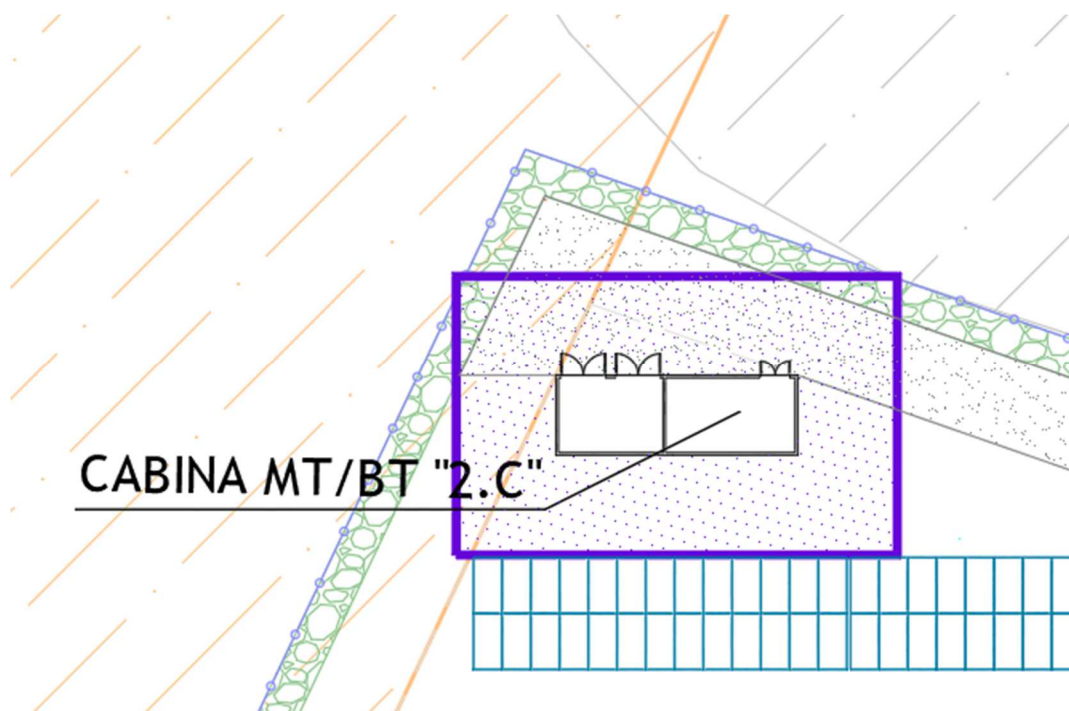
Individuazione fasce di rispetto Cabina MT/BT 2.C
